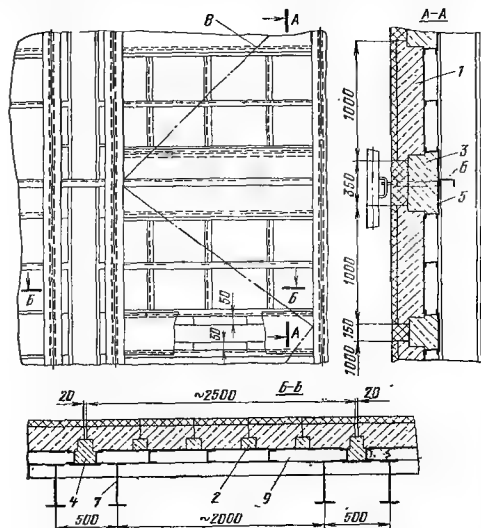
Узел обмуровки стены СРЧ из плит автоклавного изготовления.
